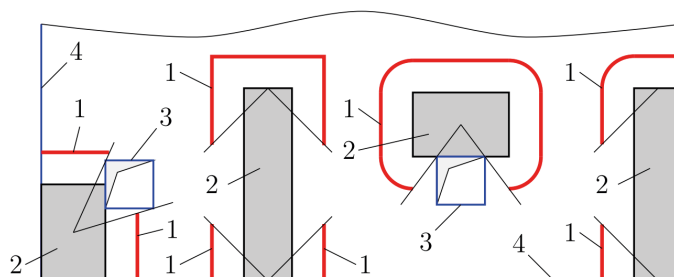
Некоторые варианты расчетных контуров: 1 – элементы расчетных контуров; 2 – площадка передачи нагрузки (колонна, пилон, стена); 3 – отверстие в плите перекрытия; 4 – грань плиты перекрытия
